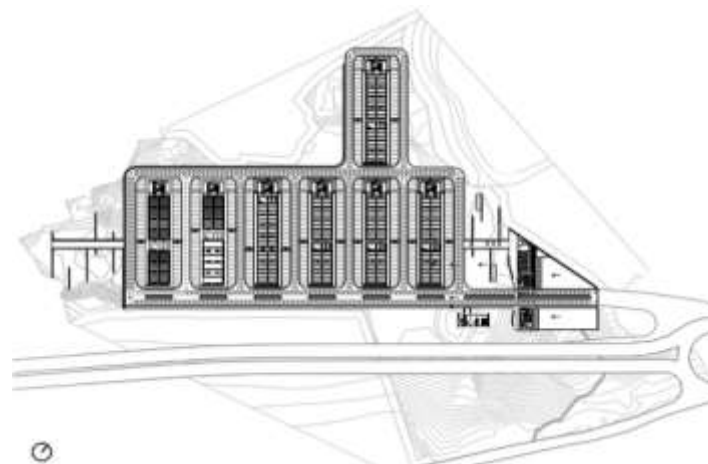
Planta General del Proyecto; Fuente: Equipo consultor arquitectónico
